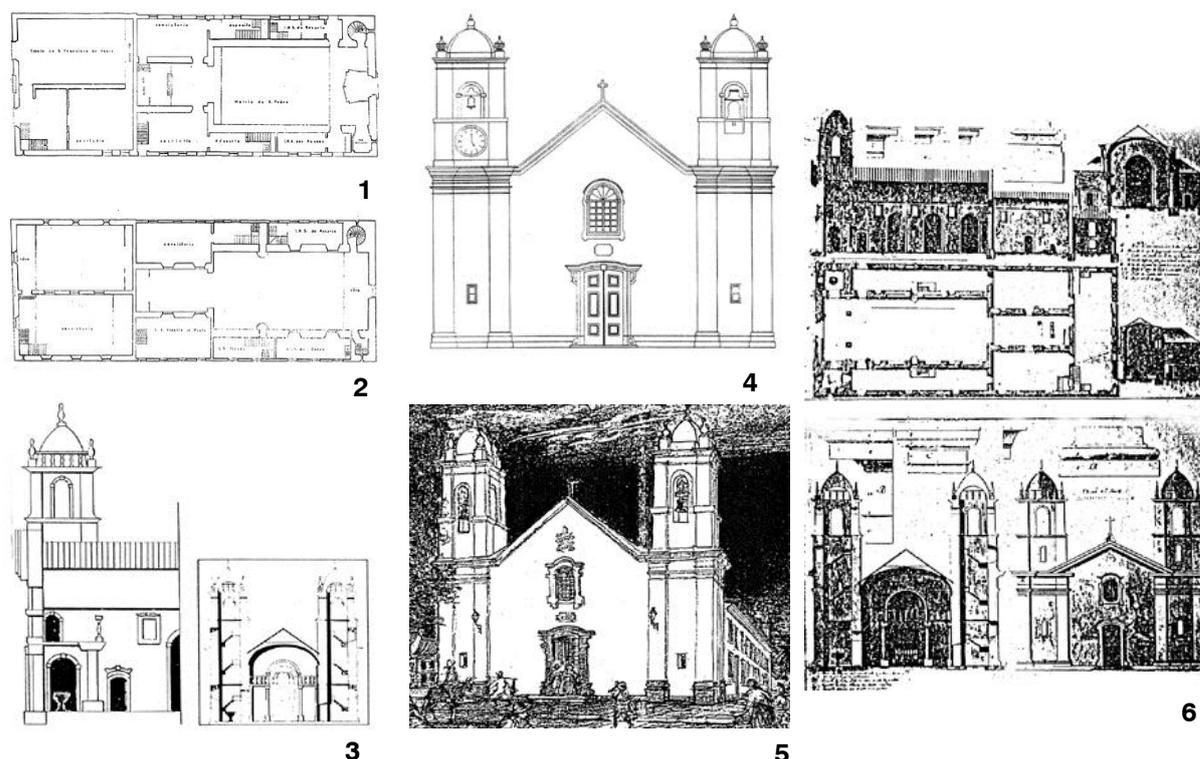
Matriz de São Pedro: 1) Planta Baixa térreo, 2) Planta Baixa 2º pavimento, 3) Cortes, 4) Fachada, 5) Desenho de Plínio Bernhardt, 6) Projeto
